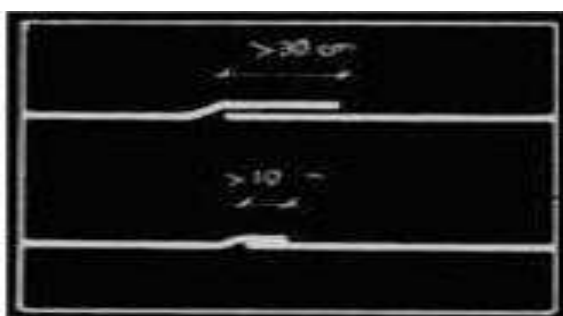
Traslapes recomendados en las uniones del geotextil (Gemia, 2011).
